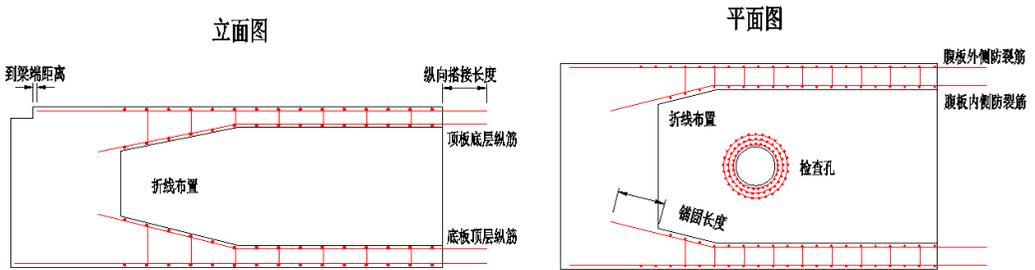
边跨现浇段钢筋-纵筋弯折绘制示意图
